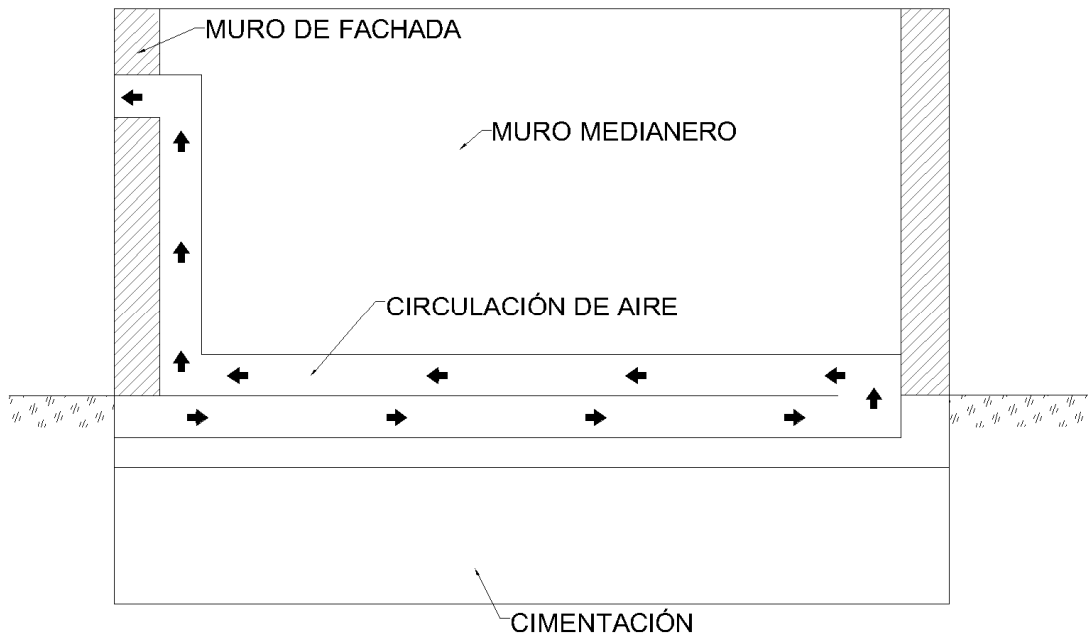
Instalación de ventilación forzada con doble recorrido en un muro medianero.
